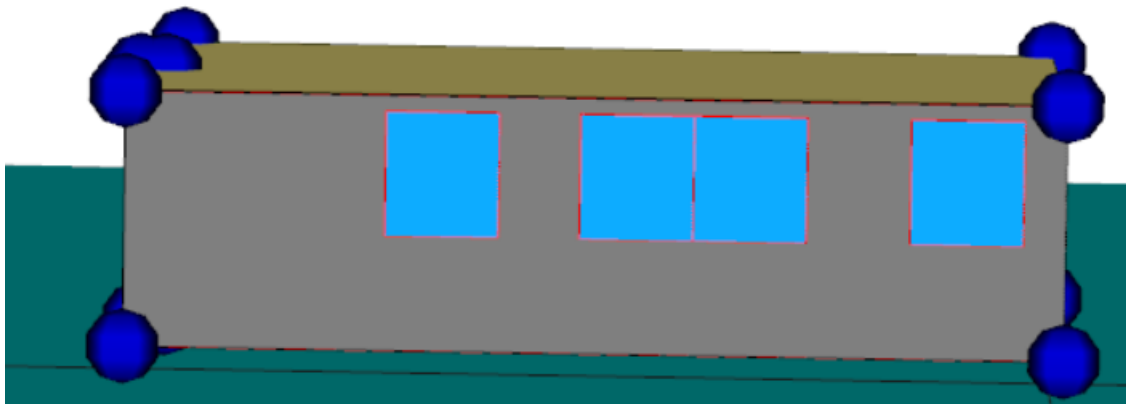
Vista en Líder Hulc Calener de Fachada Ppal Orientación Norte
